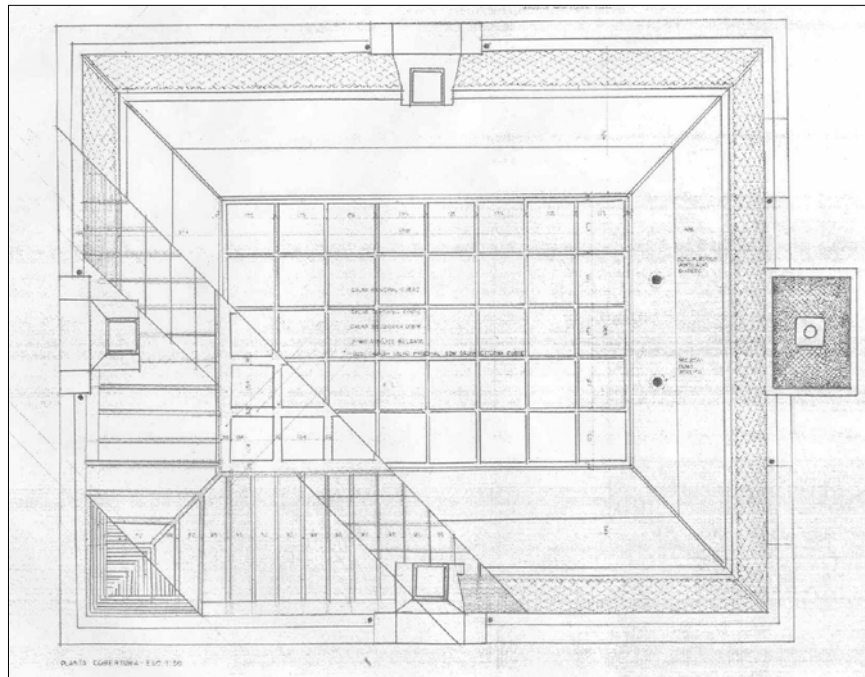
Paço Municipal. Planta Cobertura. Modificação executada após 1º restauração – 1972.
